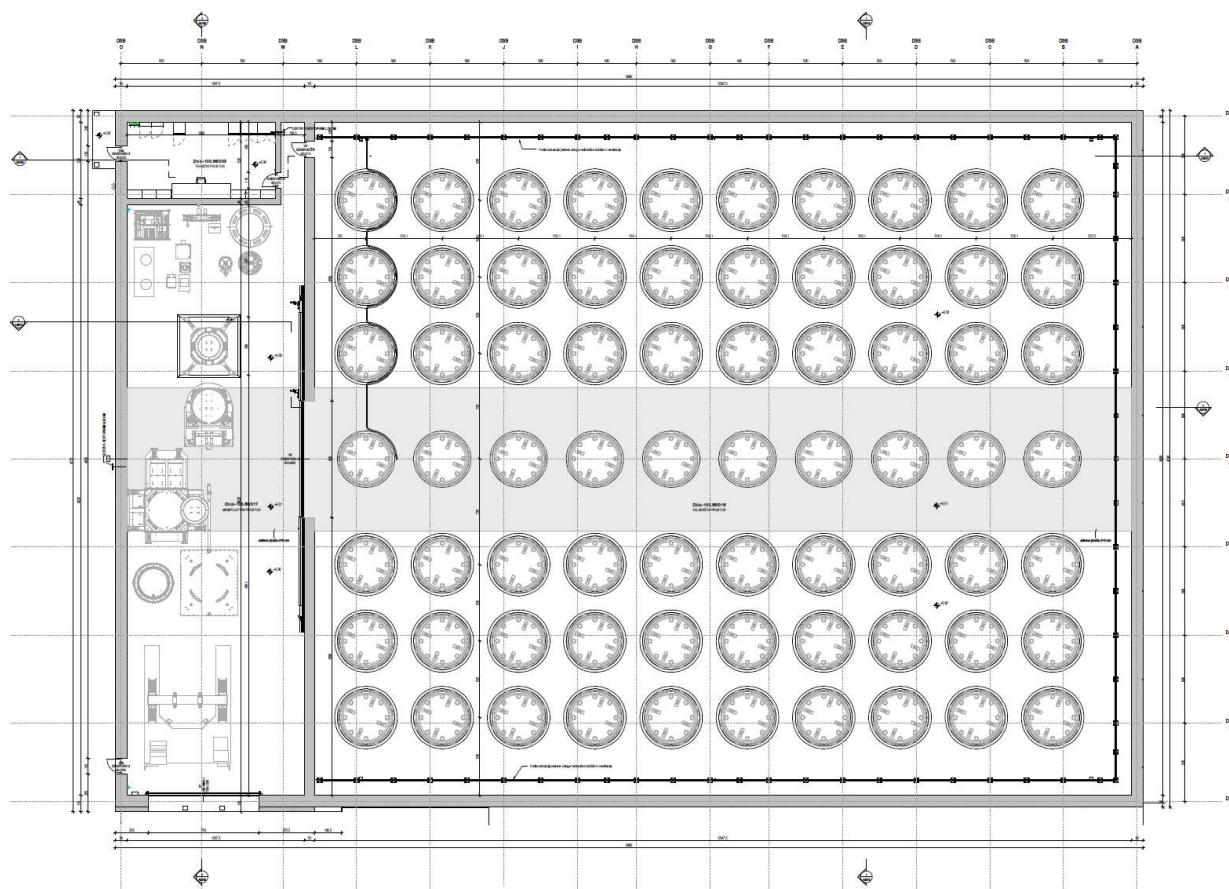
Grundriss des Trockenlagergebäudes
